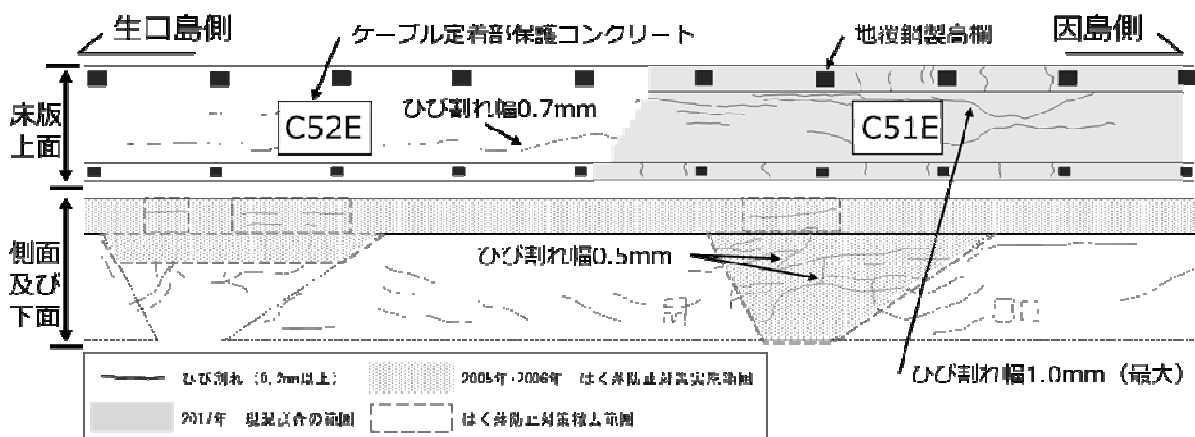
生口島側PC桁のひび割れマップ (一部抜粋)
